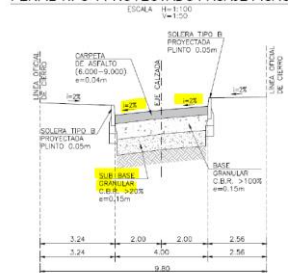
Perfil Tipo Proyectado con pavimento de la calzada y vereda
